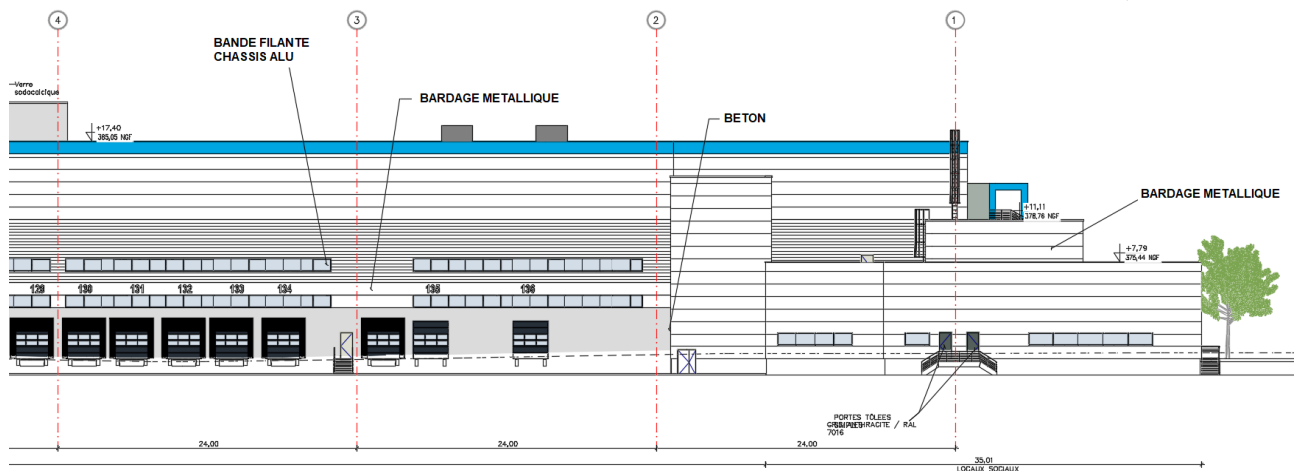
Vue sur la façade Sud entre les files 1 et 4.
